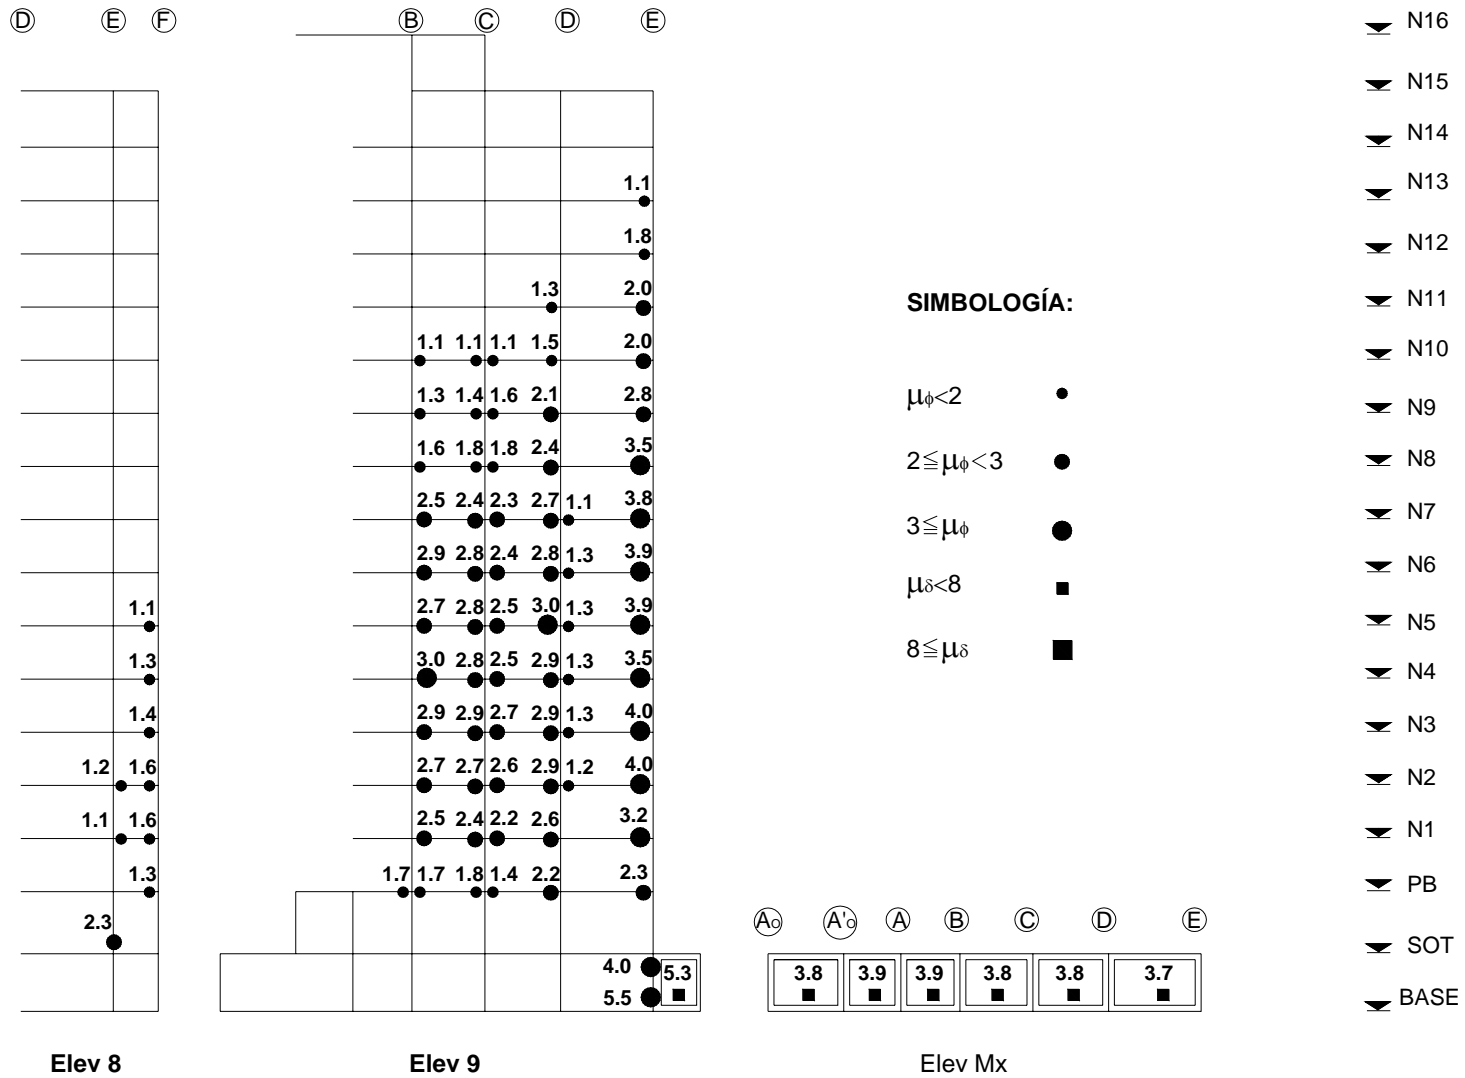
Ductilidades locales máximas de vigas, columnas y muros de concreto reforzado, en las elevaciones 8, 9 y Mx, para la SIM81
